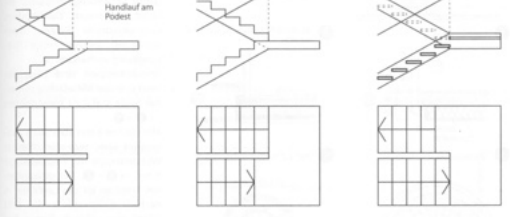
Steigungen 17/26, Geschosshöhe 2,75 m, Lauffläche 1,0 m.
